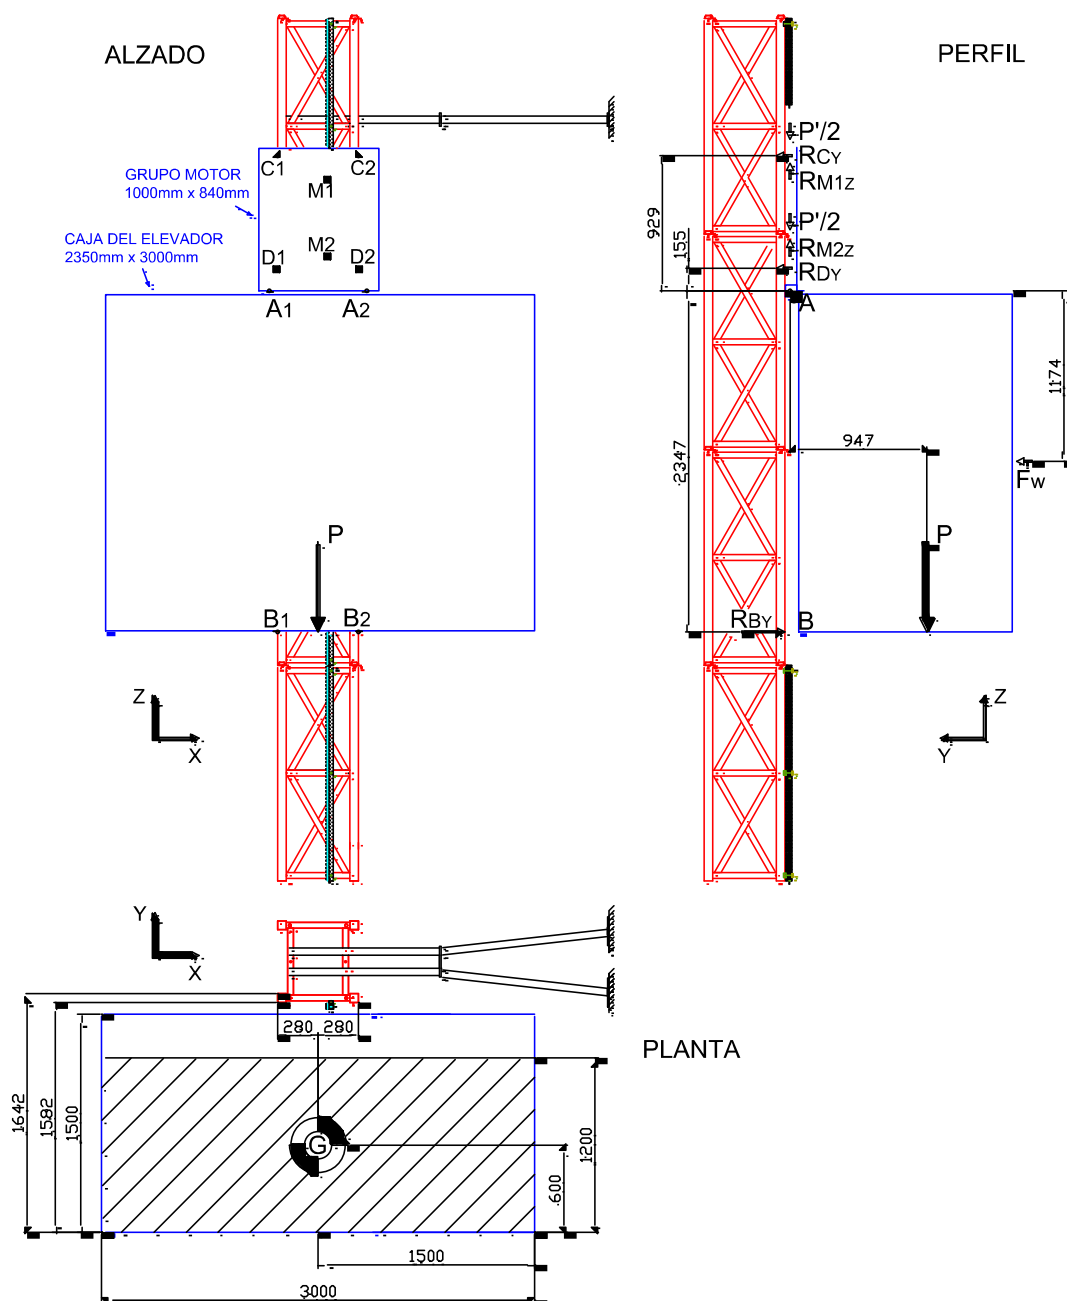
Carga uniformemente distribuida, con centro de gravedad alineado con el plano ZY de simetría del mástil y alejado en el eje Y lo máximo posible de éste.
